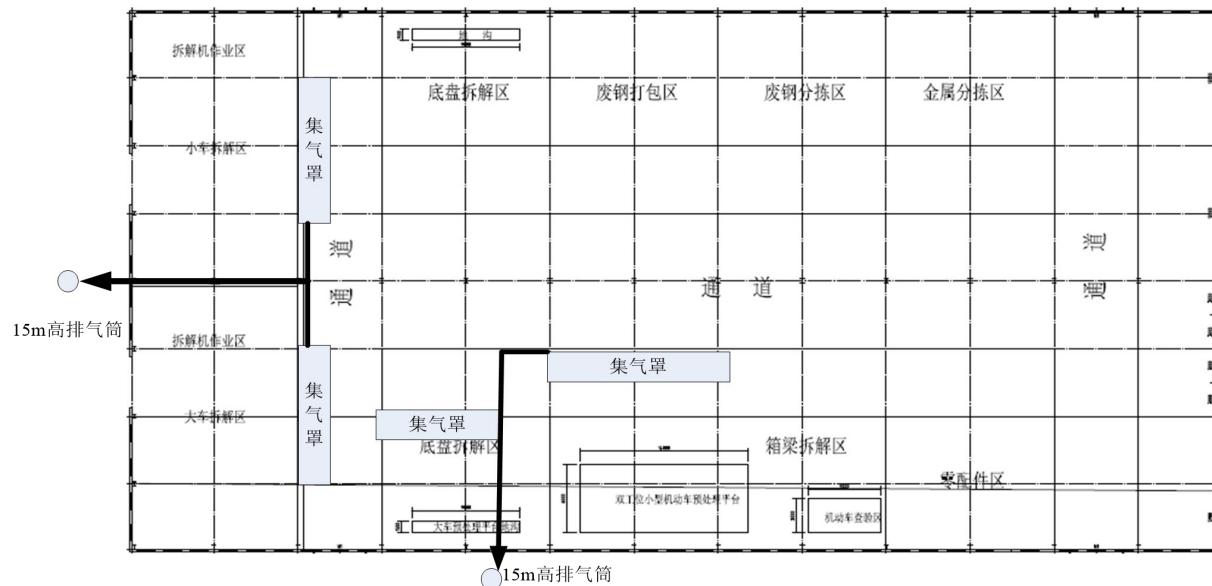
项目报废拆解车间平面布置及废气收集图
